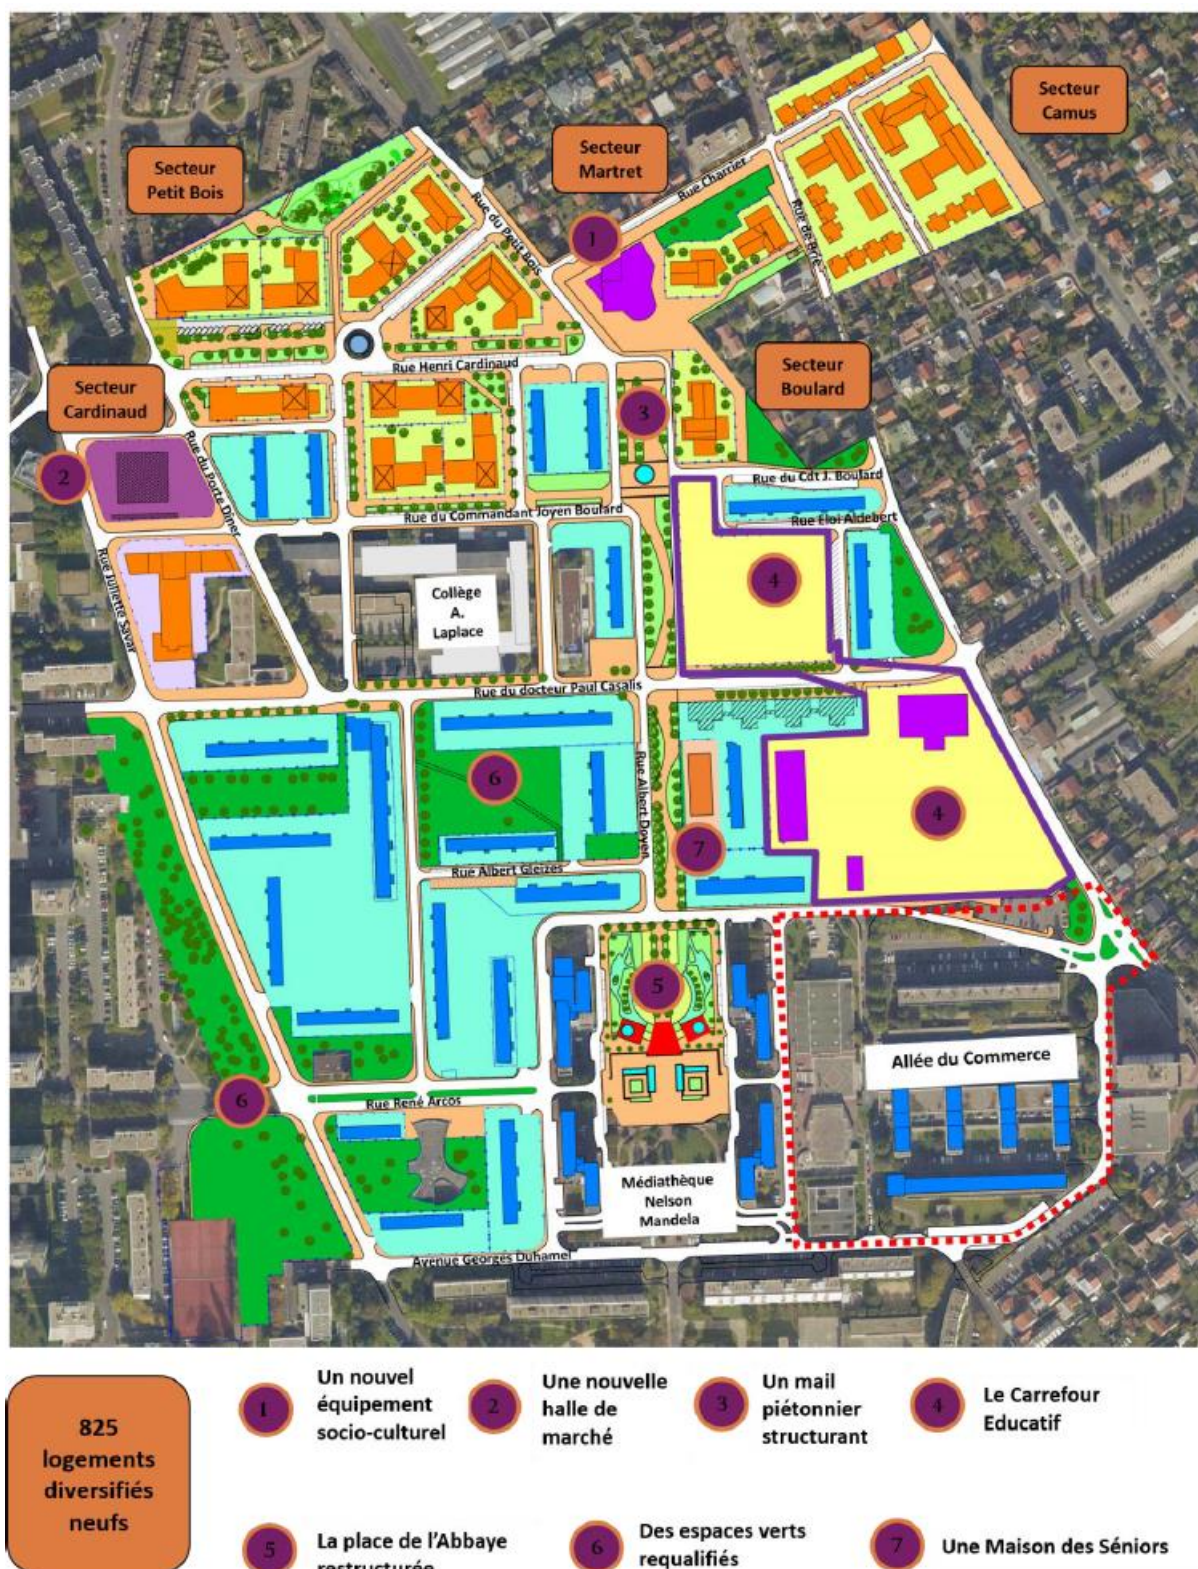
Plan masse projeté du Haut Mont-Mesly
